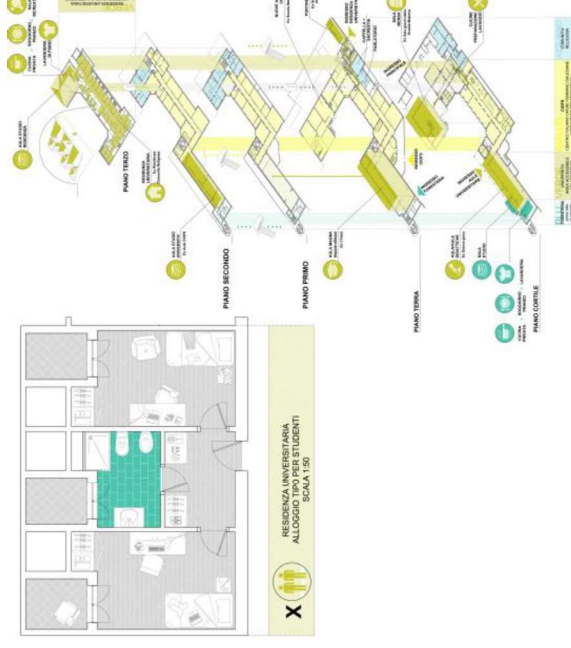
Planimetria di una camera tipo e assonometria di descrizione del progetto generale.
